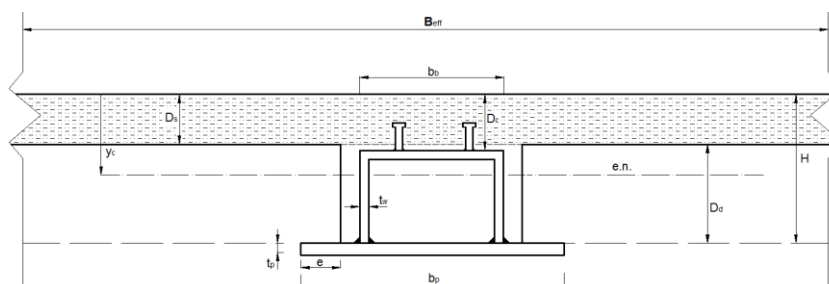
Secção de uma viga mista do tipo *HatBeam*.
